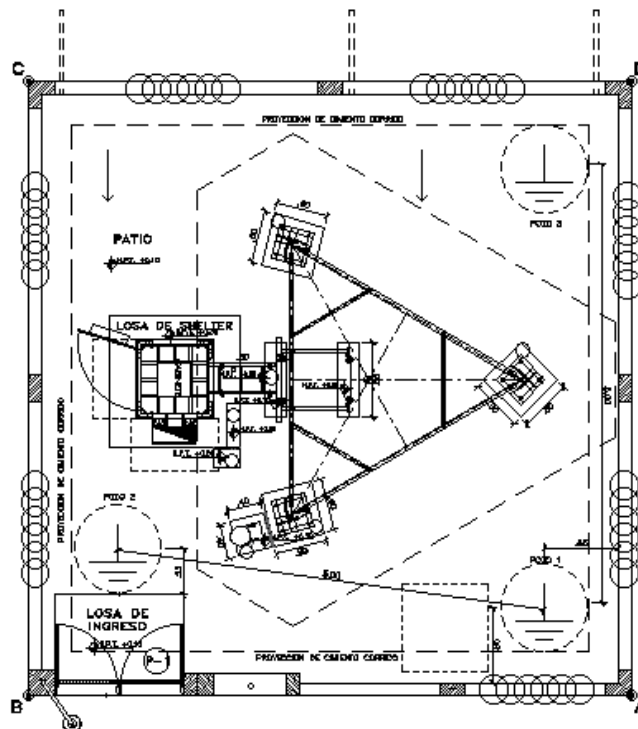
Distribución arquitectónica típica un Nodo tipo Acceso
